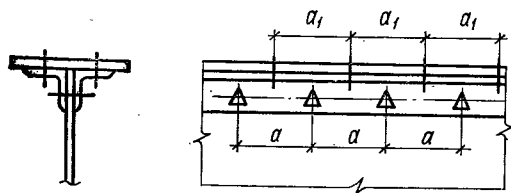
К расчету поясных соединений на высокопрочных болтах.
